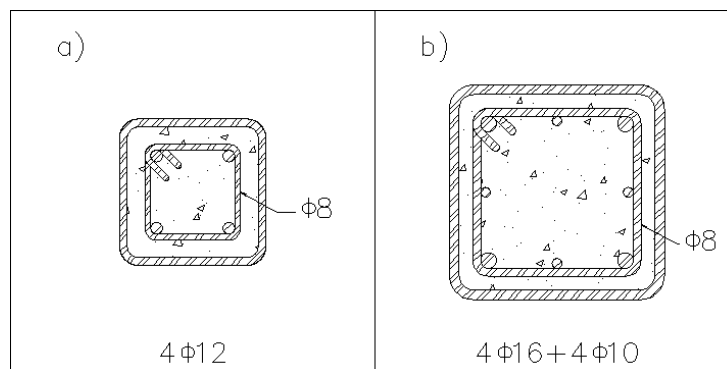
Corte transversal dos modelos experimentais: a) 150 mm de lado; b) 220 mm de lado
